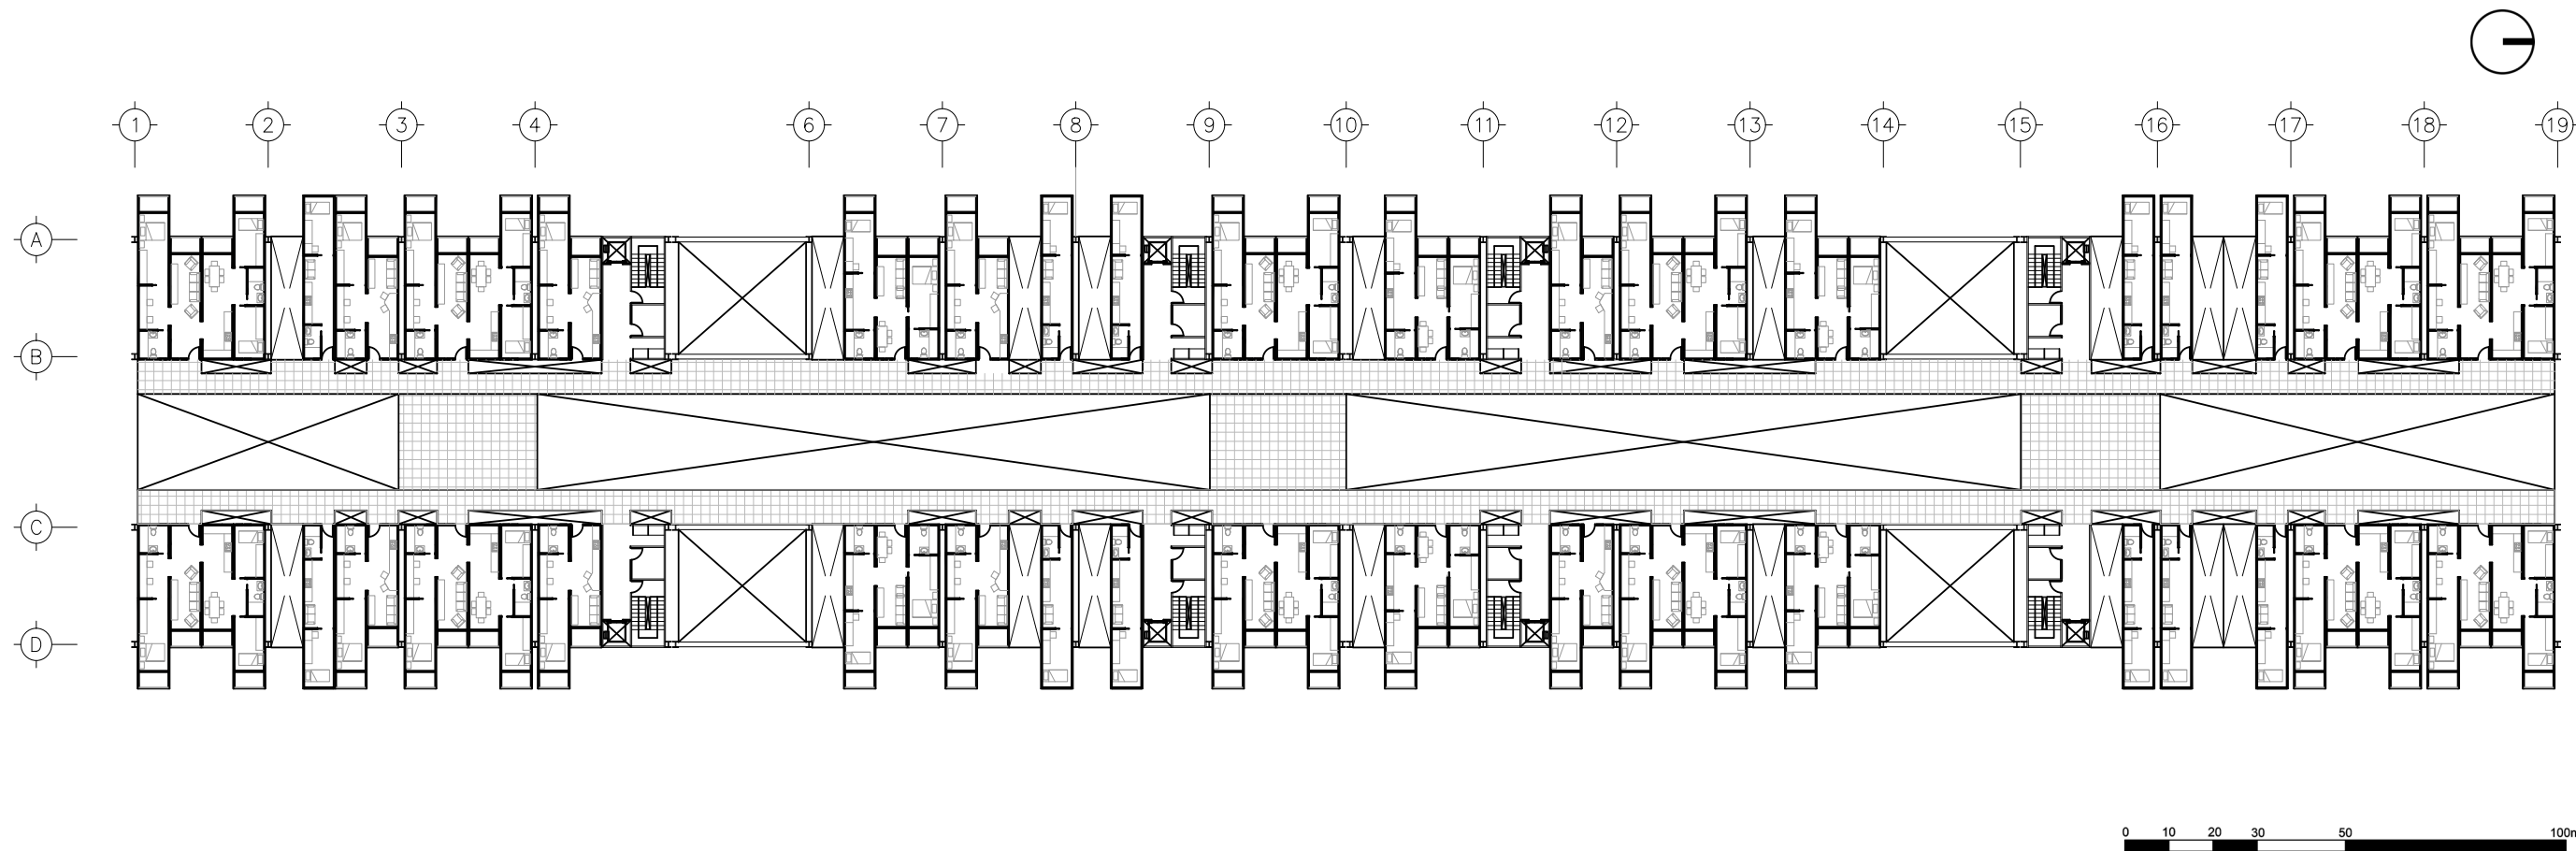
Planta sub suelo nivel - 3.00m y - 4.00m
